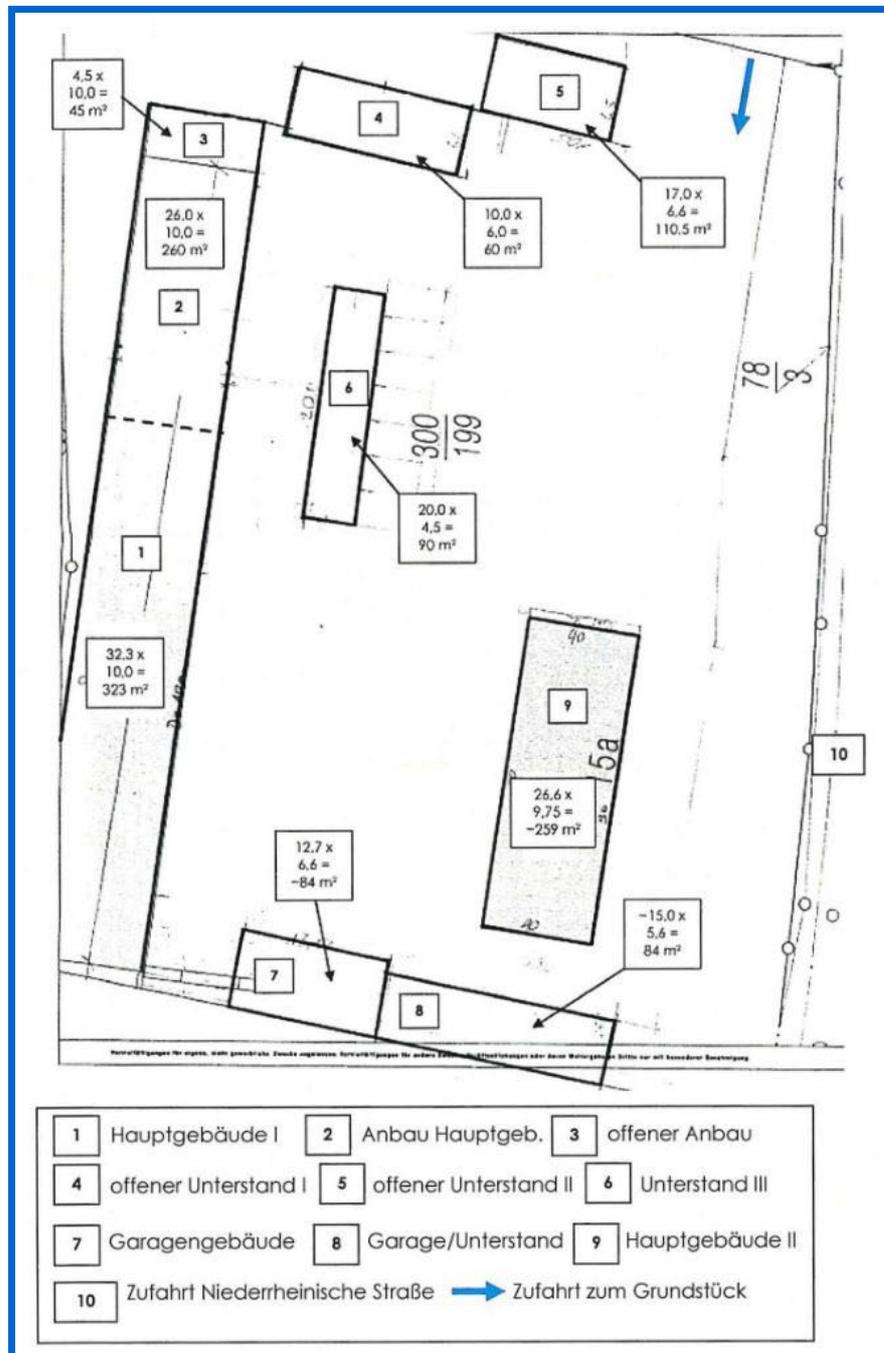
Lage des ehemaligen Baubetriebshofs der Stadt Stadallendorf in der Niederrheinischen Straße mit Gebäude-/Anlagenbezeichnungen im Detail (Quelle [U19] (Ausschnitt, Daten unverändert))
